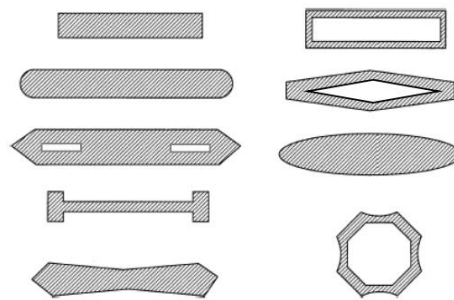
3 –Tipikal profil melintang pilar pada darat
